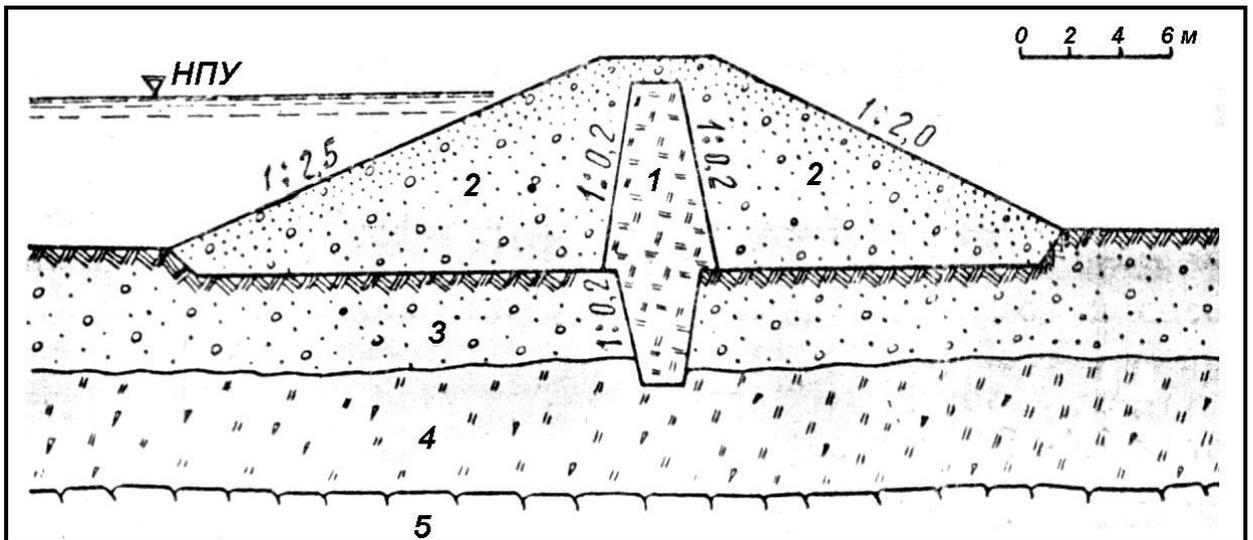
Земляная насыпная плотина на ручье Кадыкчан, 1966 г.
